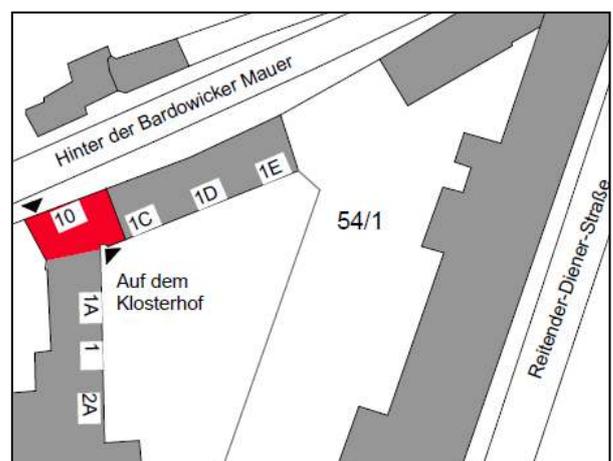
Lageplan, Ausschnitt nördl. Klosterhof
